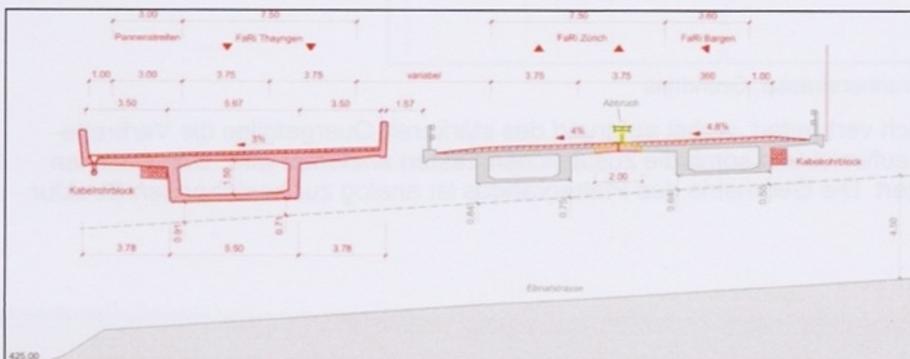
Unterführung Gemeindestrasse Muracker, Brücken-Querschnitt
